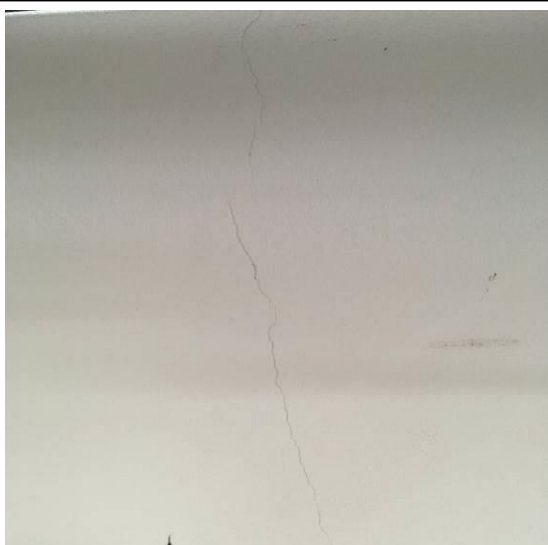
Bâtiment A RDC, salle info 1 - Plancher haut : D2– Fissuration modérée.
